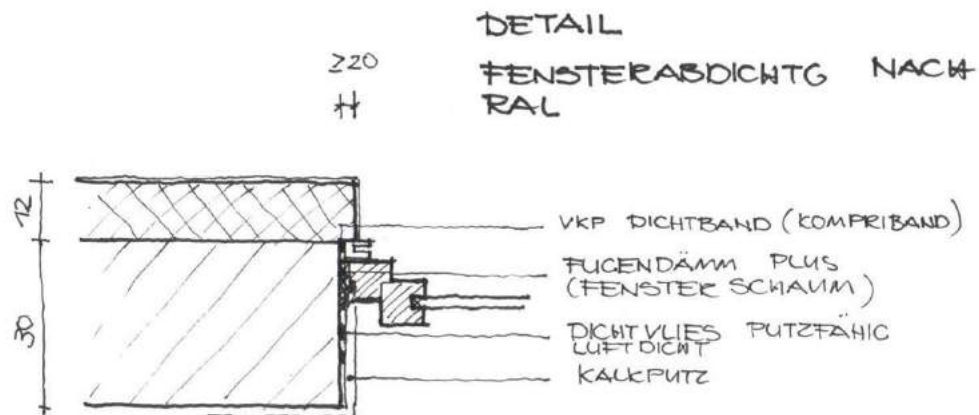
Detailskizze Fensterabdichtung und Balkontüranschluss
